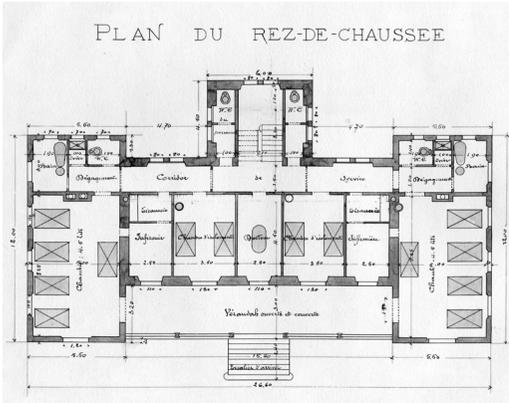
Montreux, lazaret de La Foge, plan, Louis Villard architecte, 1896 (AM).
